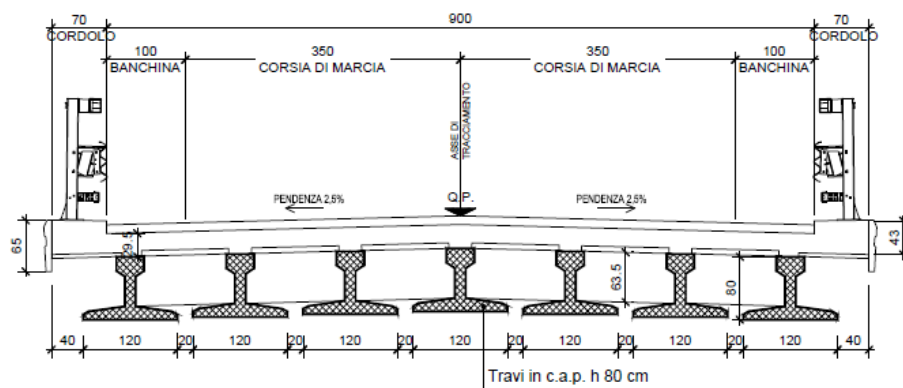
4 SEZIONE IN CORRISPONDENZA DEI PONTI SU RONDONE PRIMO ESU CAVO PORRETTO
